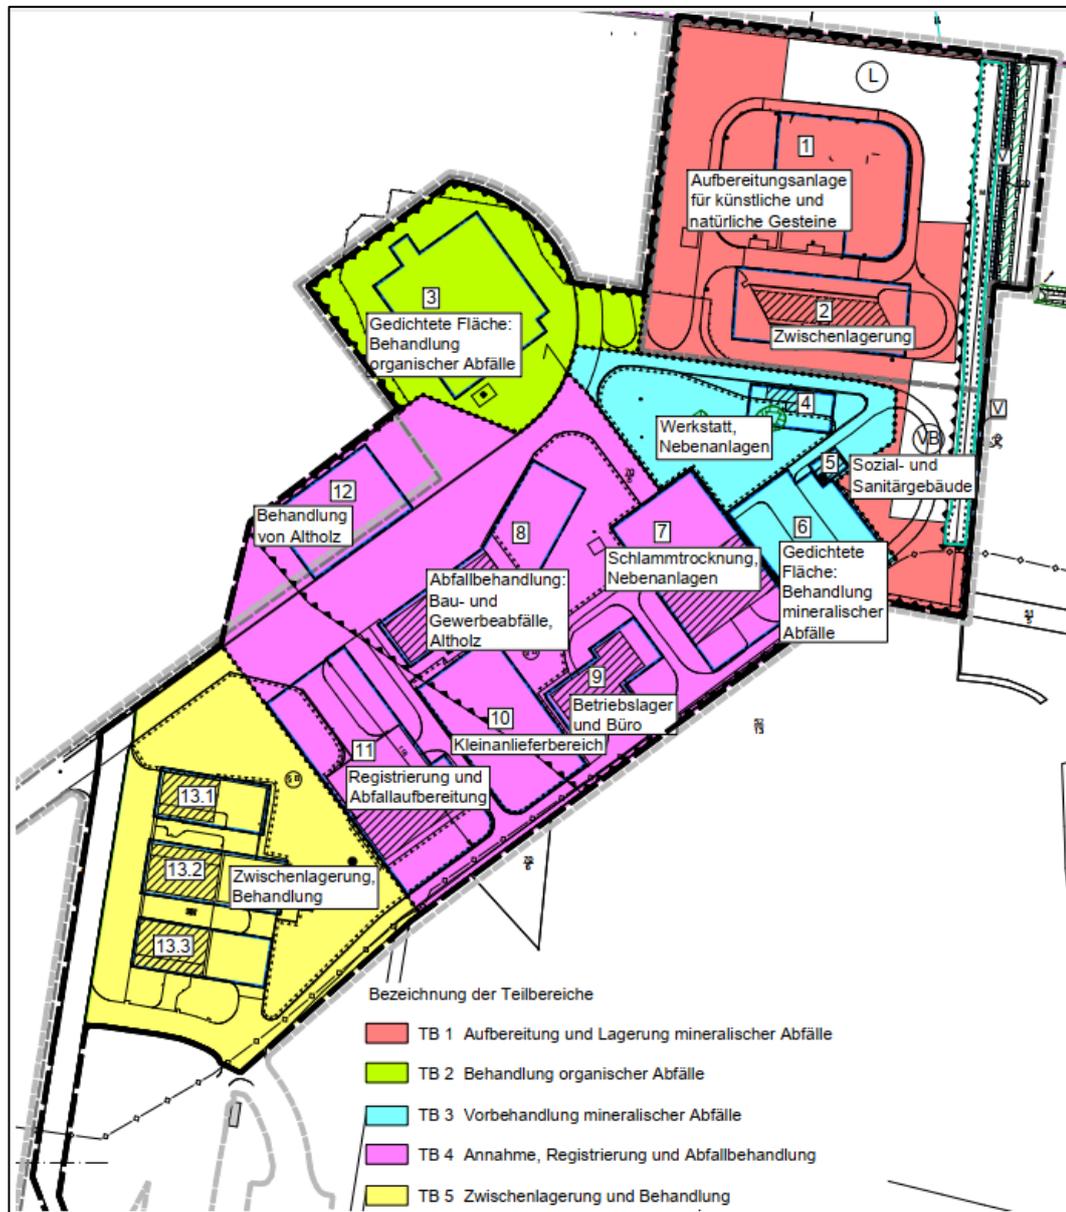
Geplanter Standort mit Teilbereichen und baulichen Anlagen
